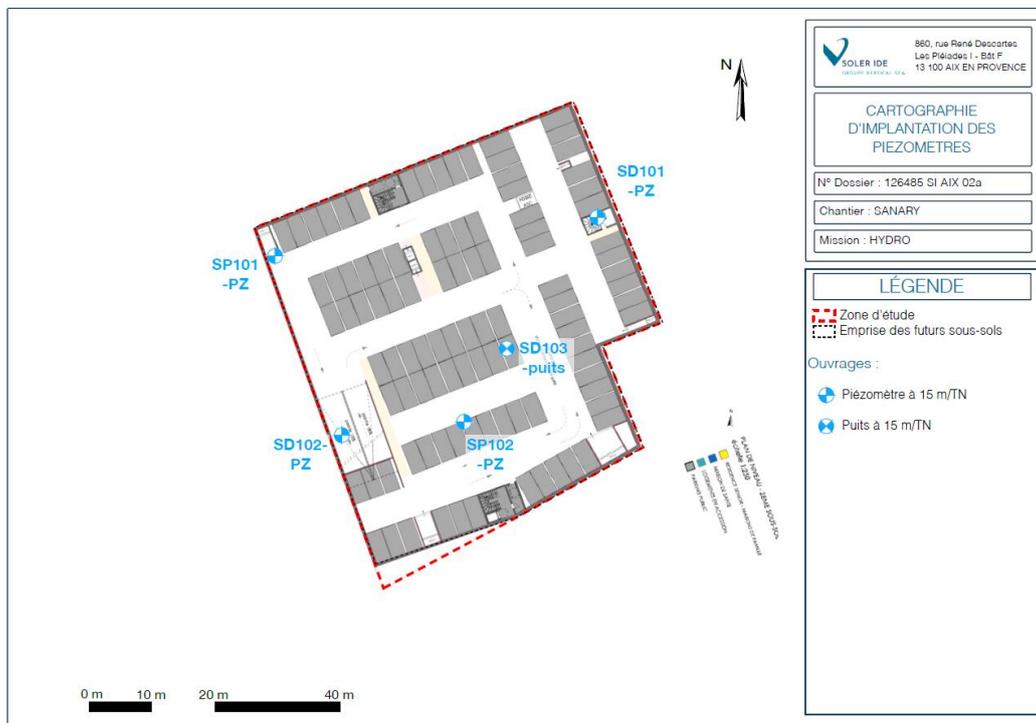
Plan d'implantation des piézomètres – Source : SOLER-IDE
